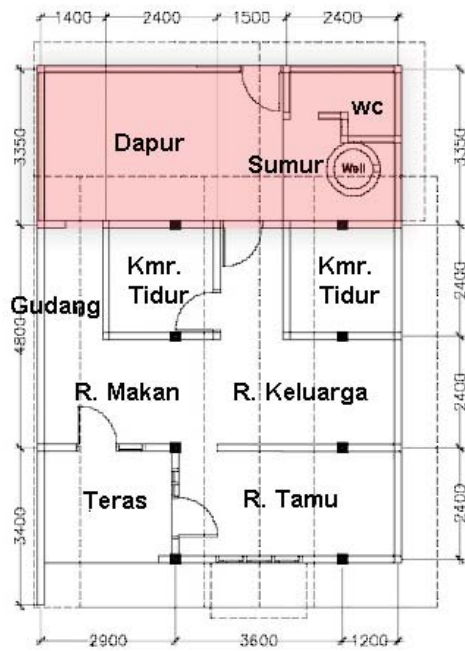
Denah Konfigurasi Modul Struktur Memanjang Pada Rumah no. 49 dan 50 Dengan Penambahan Bangunan Struktur Beton Bertulang di Samping Rumah no. 50.
